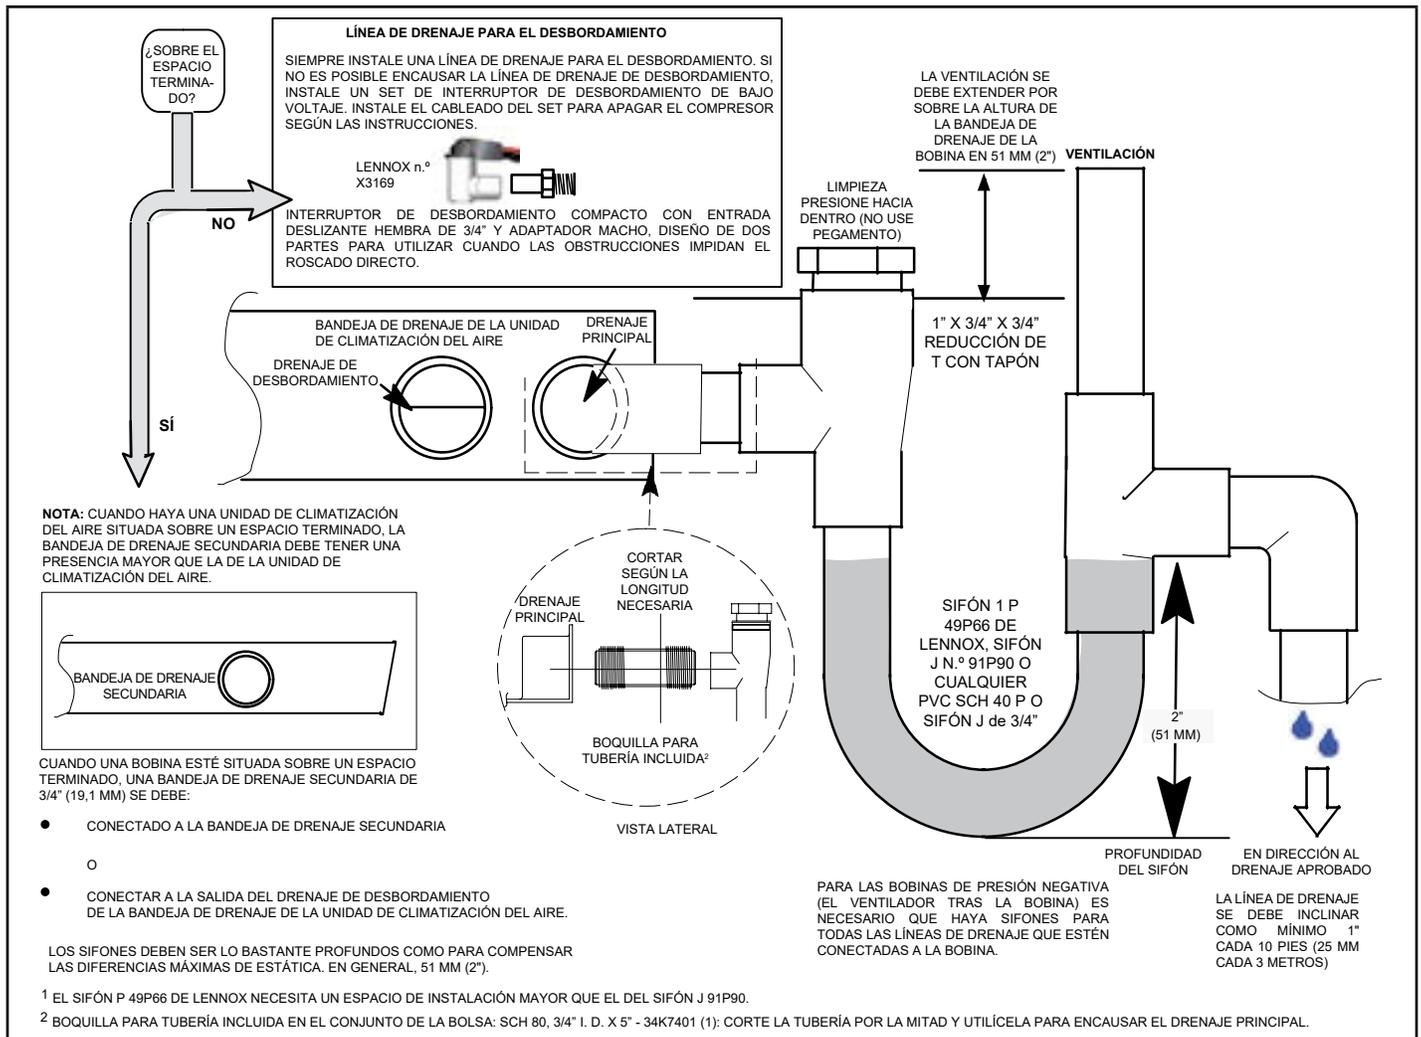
Instalaciones de drenaje principal y rebosadero habituales
